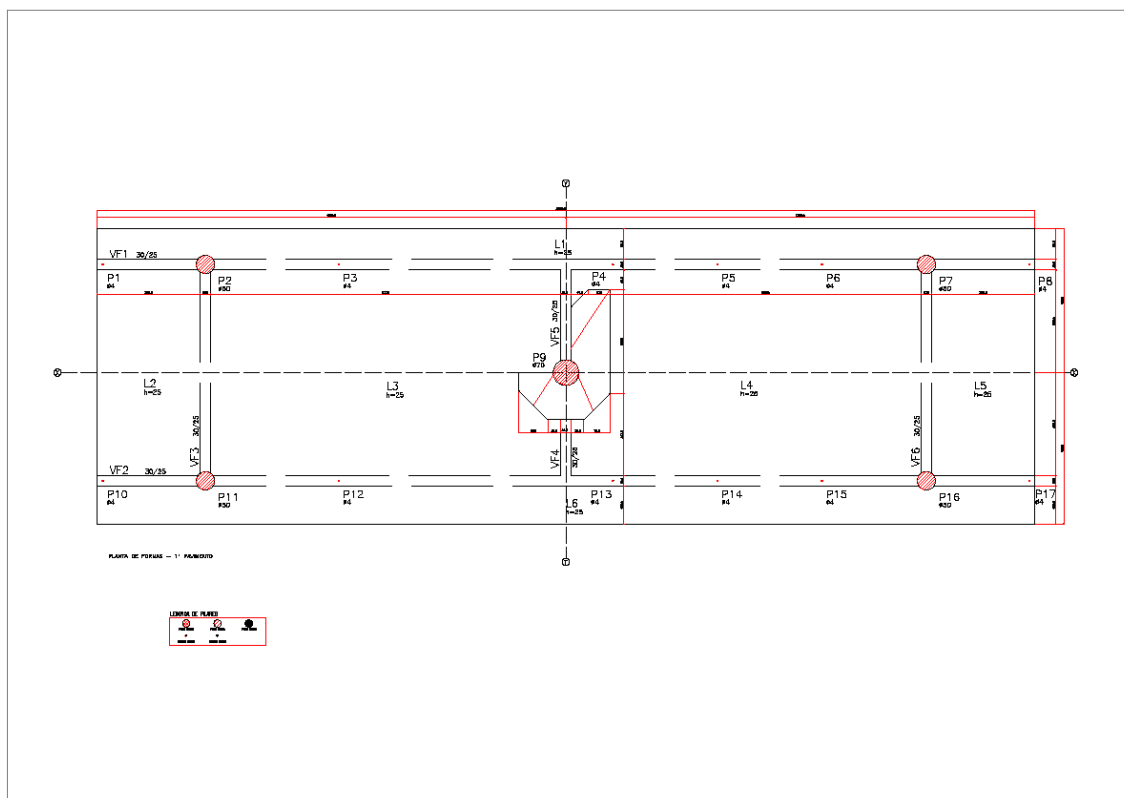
1º pavimento: planta de formas. Fonte: AUTOR (2017).
